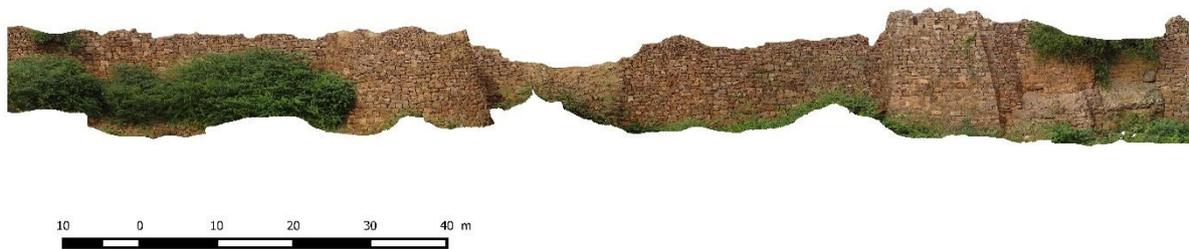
réparation Bahmani ou Adil Shahi de la muraille entre la tour 56 et la porte 25 (à droite de l'image). Un haut crénelage est ajouté lors de cette reconstruction
